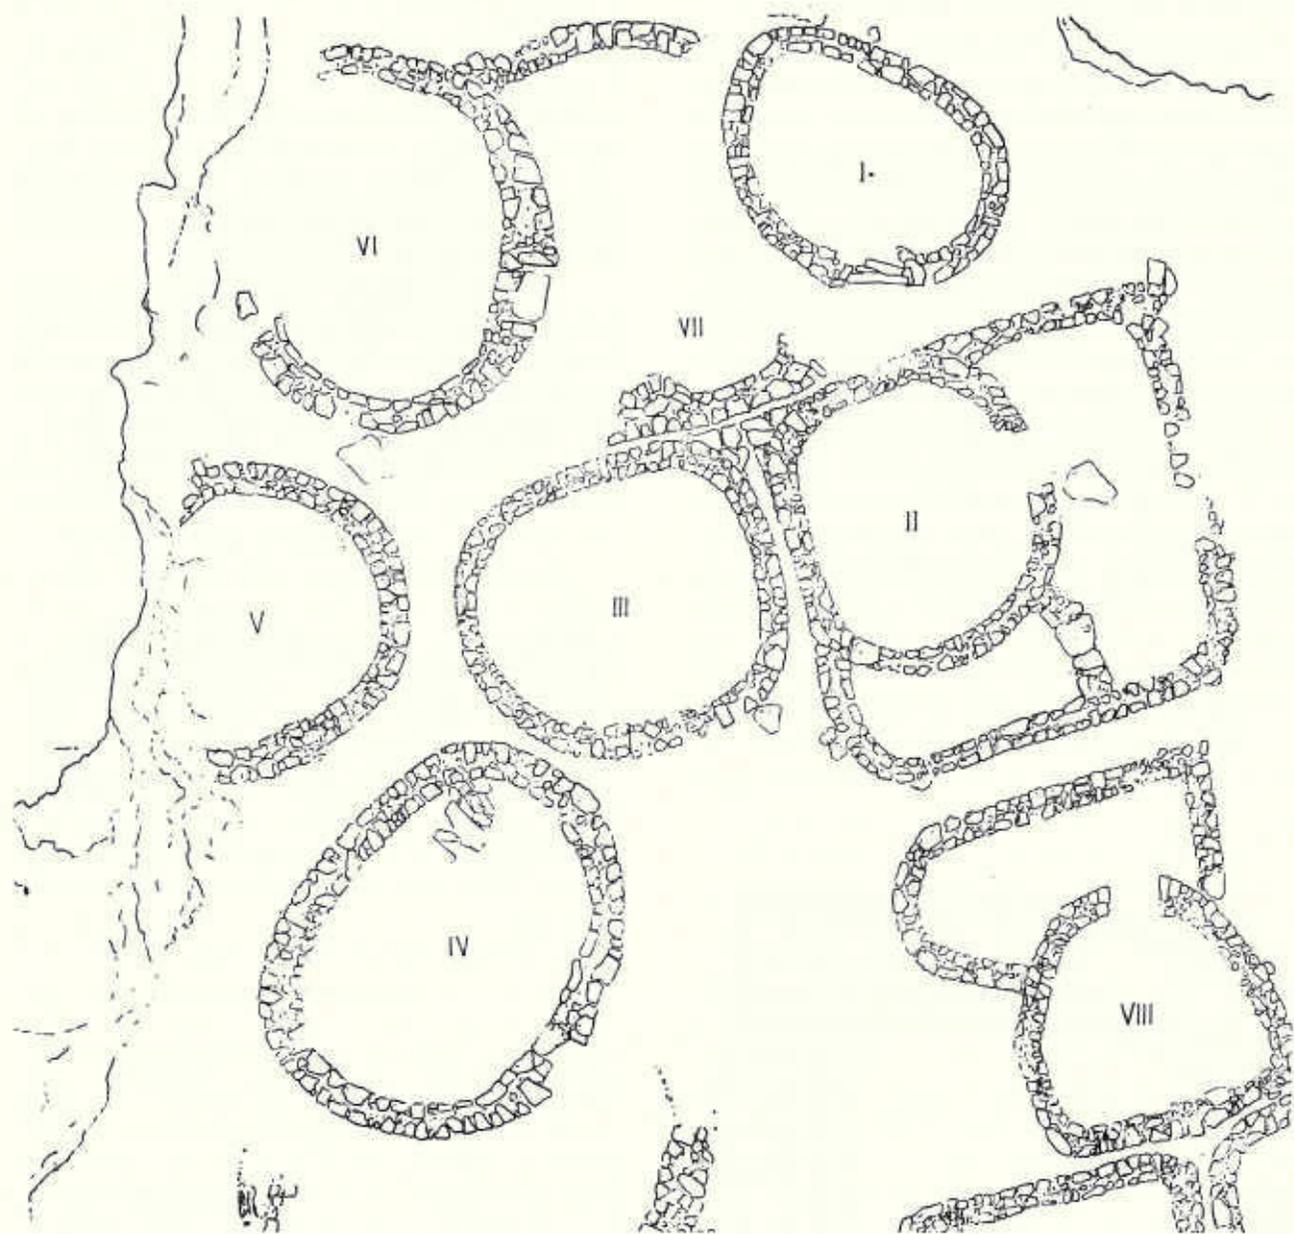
Particolare della planimetria del villaggio del Milazzese (Panarea)
